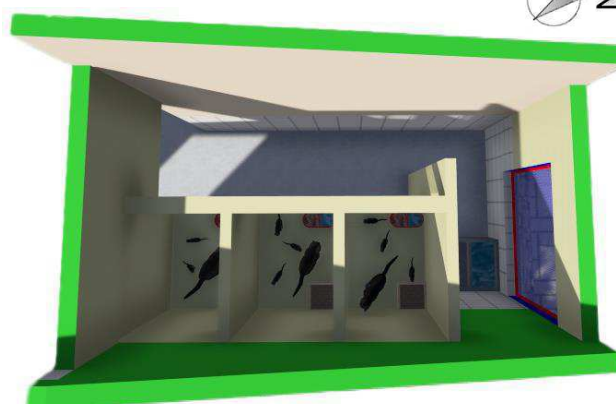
Propuesta de jaulas para hembras con crías. Fuente: Propia
